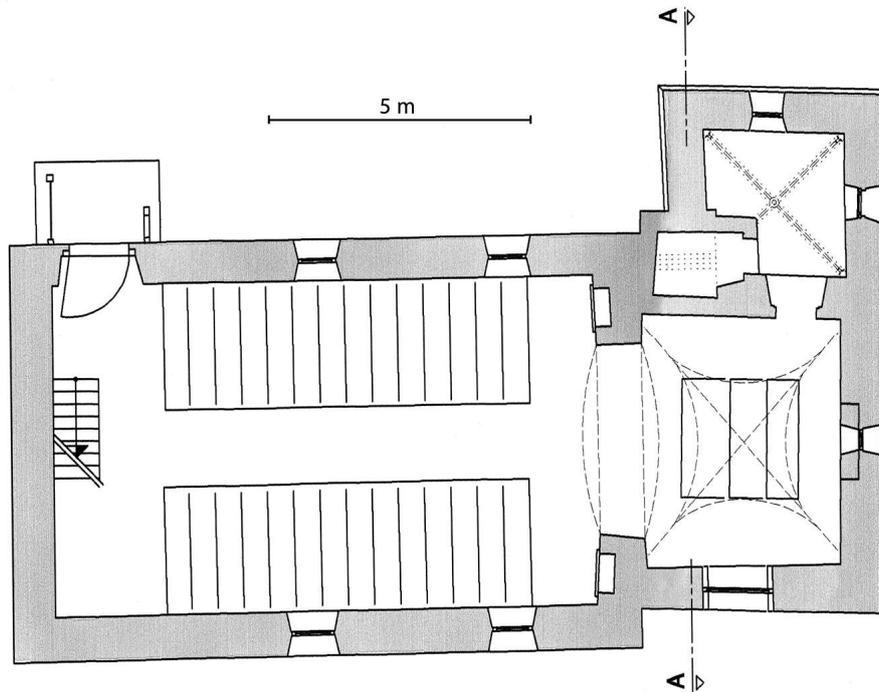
Stephansposching-Uttenhofen. Grundriss der Nebenkirche Mariä Himmelfahrt (Büro für Architektur und Stadtplanung Schnabel & Partner).
